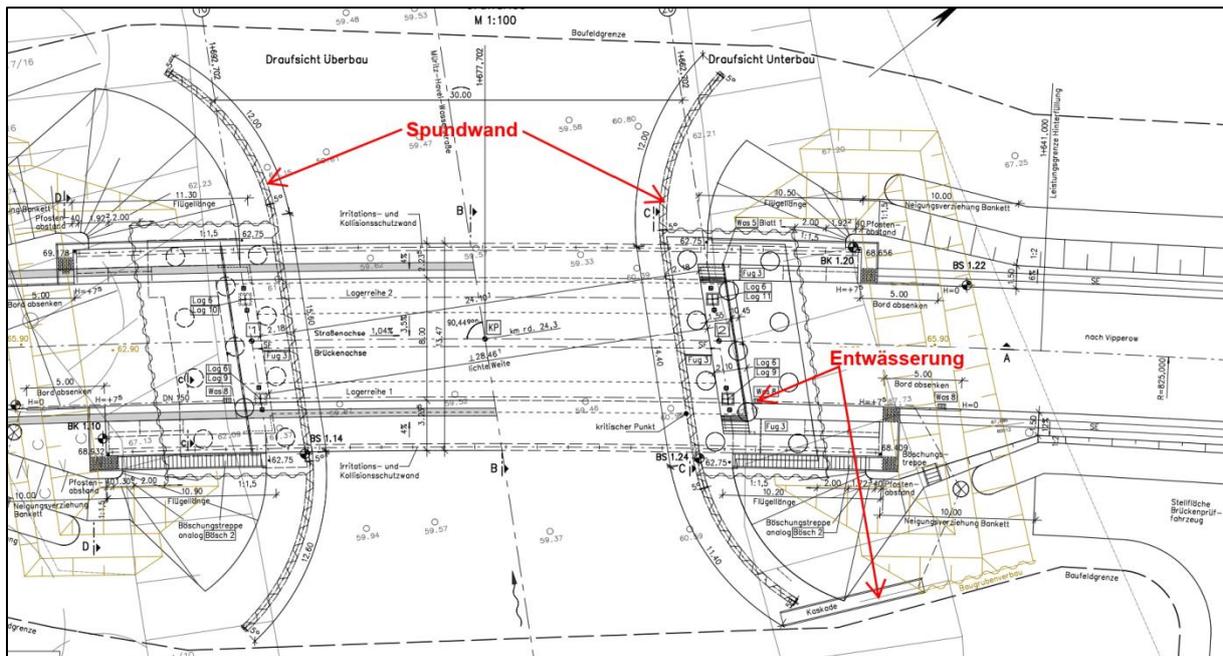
Grundriss Brückenbauwerk BW 1 W. Draufsicht mit Spundwänden (nachrichtliche MIV-NEUSTRELITZ 2020i)
